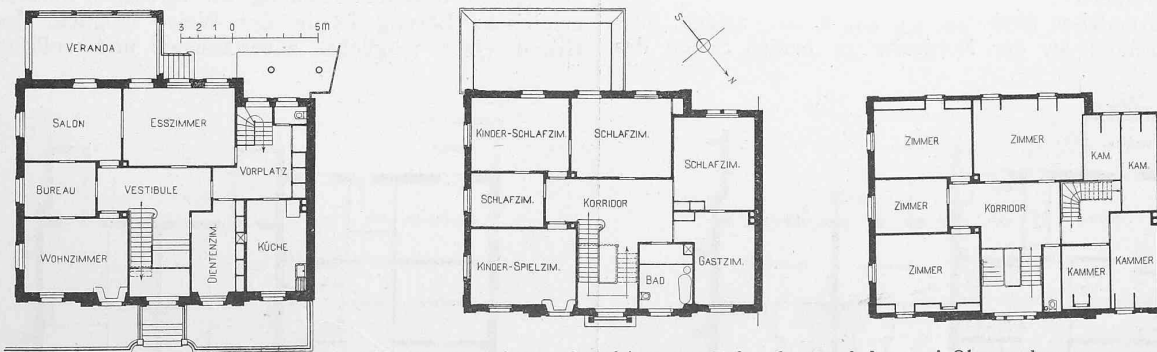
, 34 und 35. Grundrisse vom Erdgeschoss und den zwei Obergeschossen. — 1:400.
